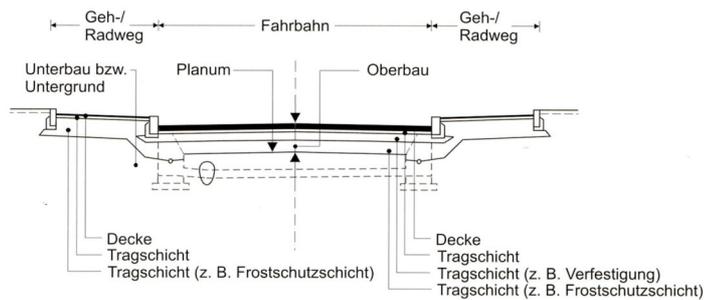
Beispielhafter Aufbau einer Befestigung in geschlossener Ortslage mit teilweise wasserundurchlässigen Randbereichen sowie mit Entwässerungseinrichtungen
